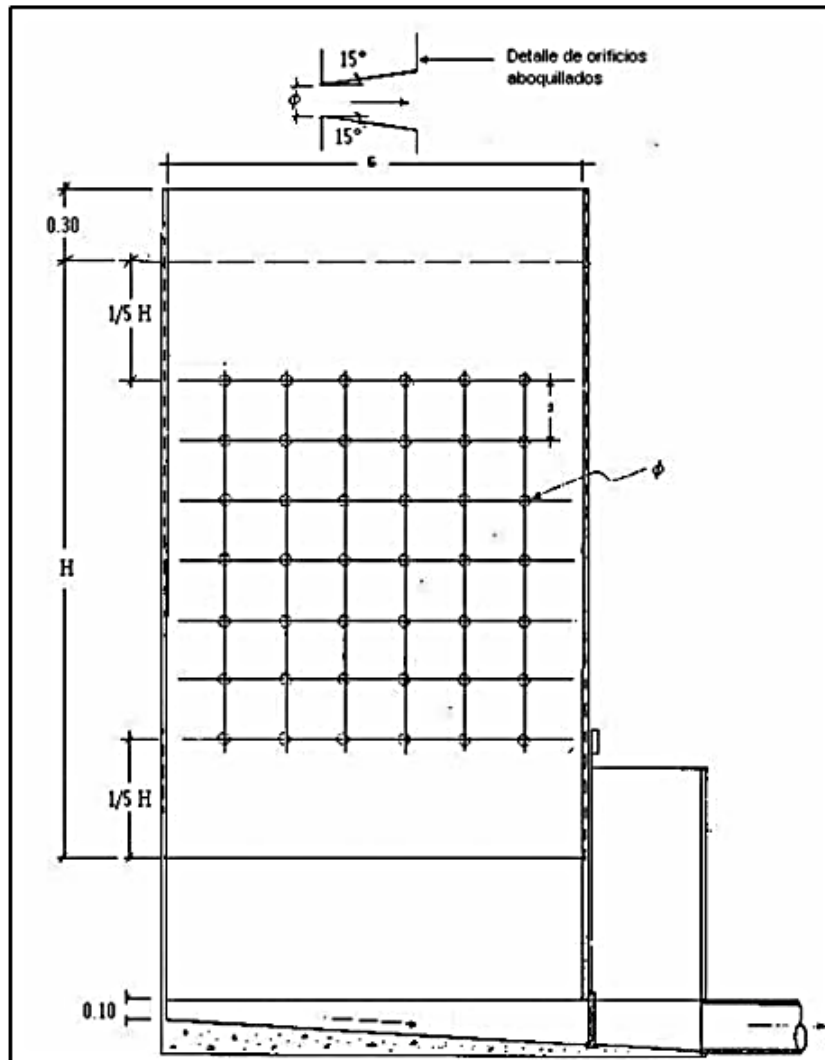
Detalle para dimensionamiento de partes del desarenador. Fuente: Tomado de [2].
